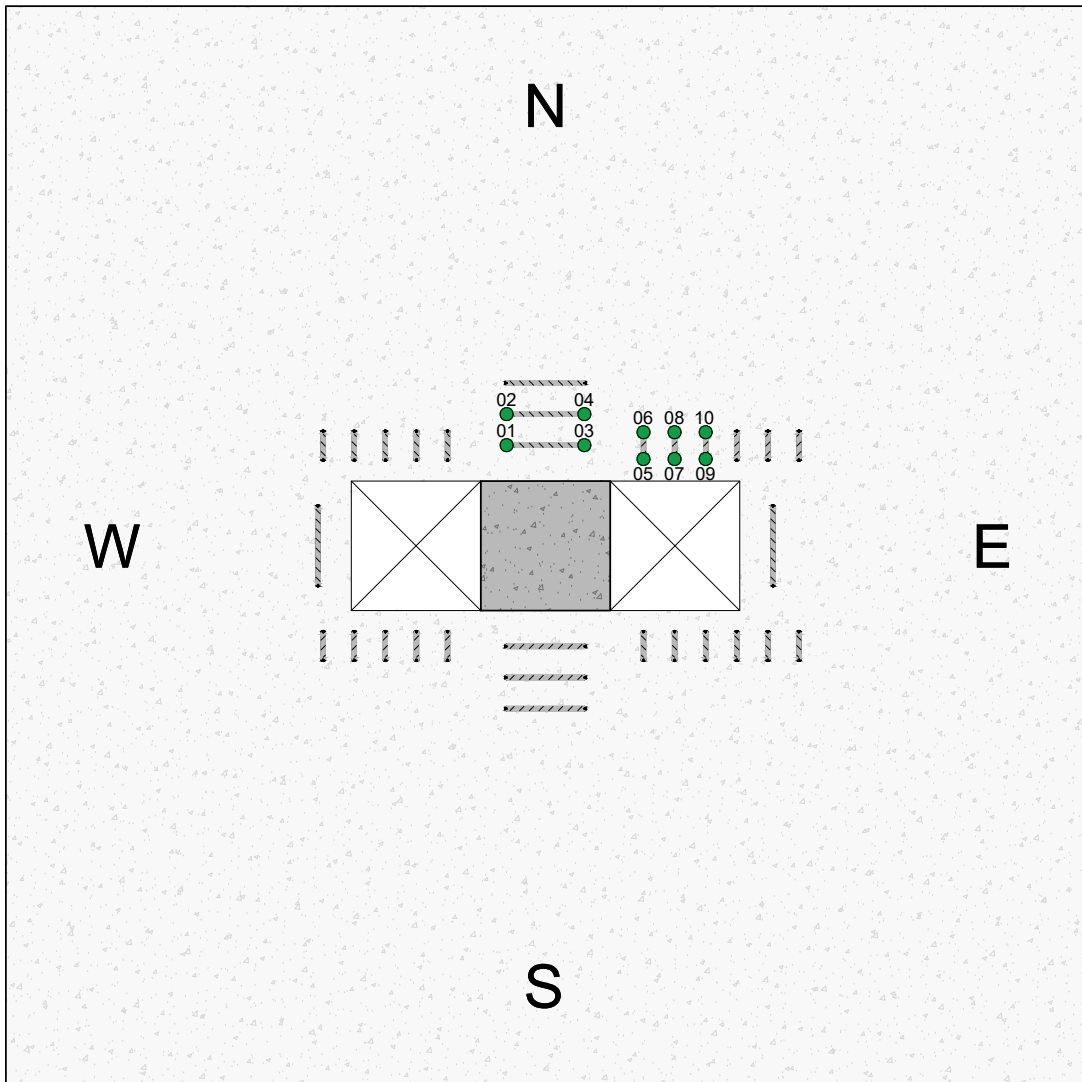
Posicionamento dos extensômetros nos estribos da laje LFE2 [mm]
